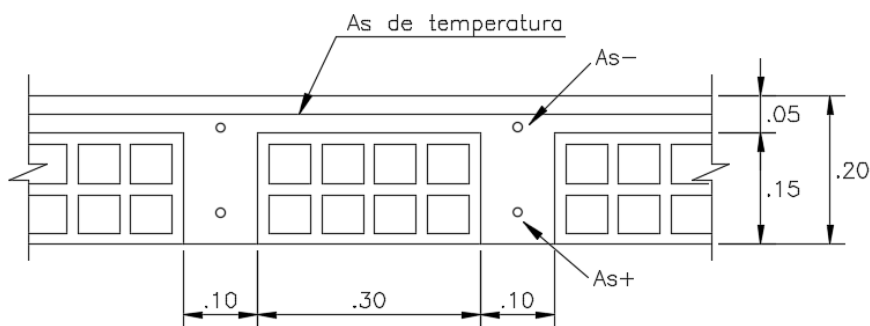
Sección típica de losa aligerada de 20 cm de peralte
